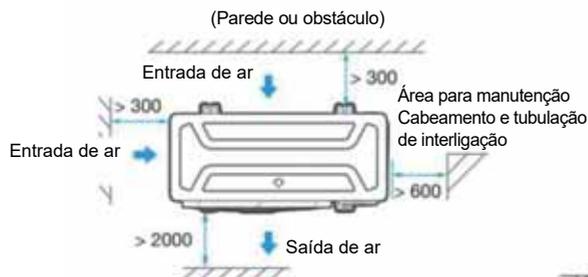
Vista lateral da instalação de somente uma unidade central (dimensões: mm)
